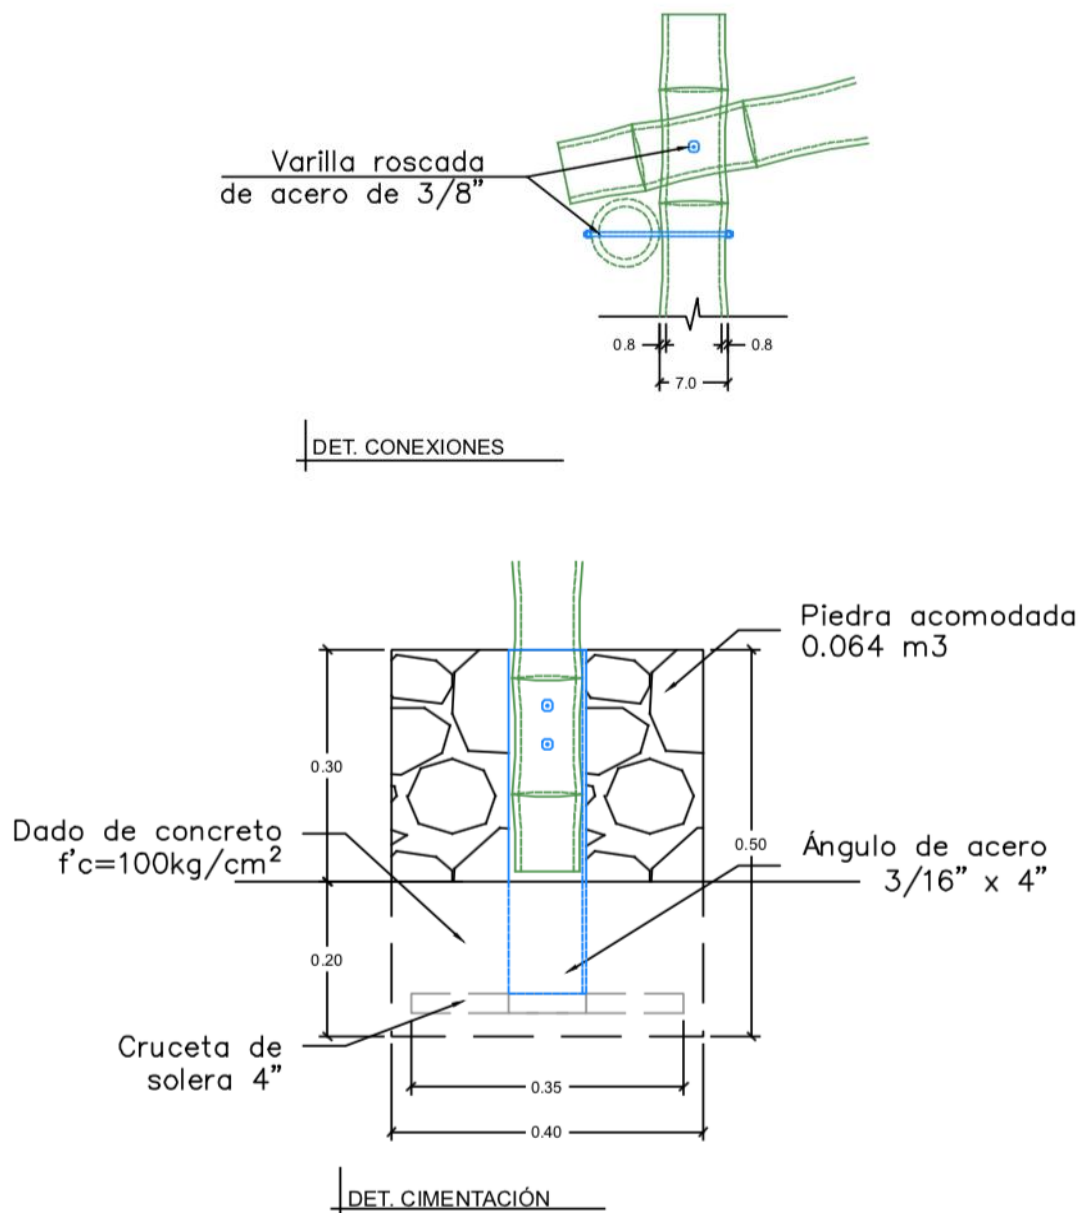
Detalles de estructuración de cubierta. (Creación propia 2022)
